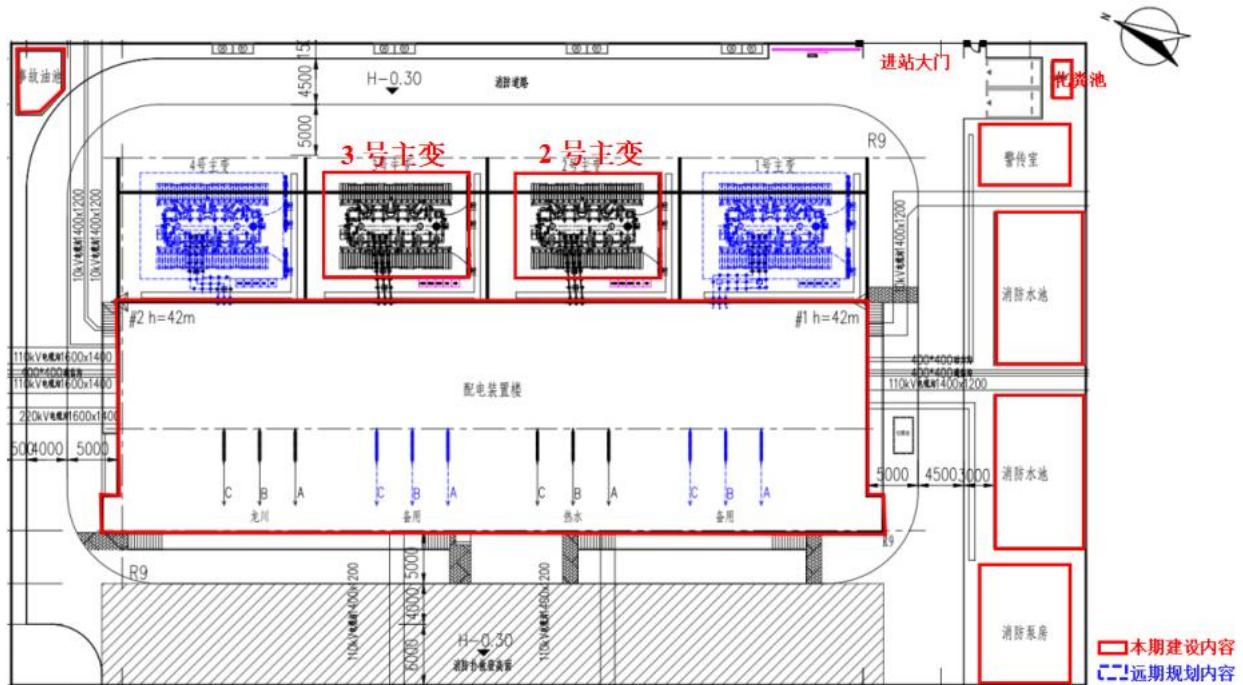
拟建 220 千伏登云变电站总平面布置示意图
